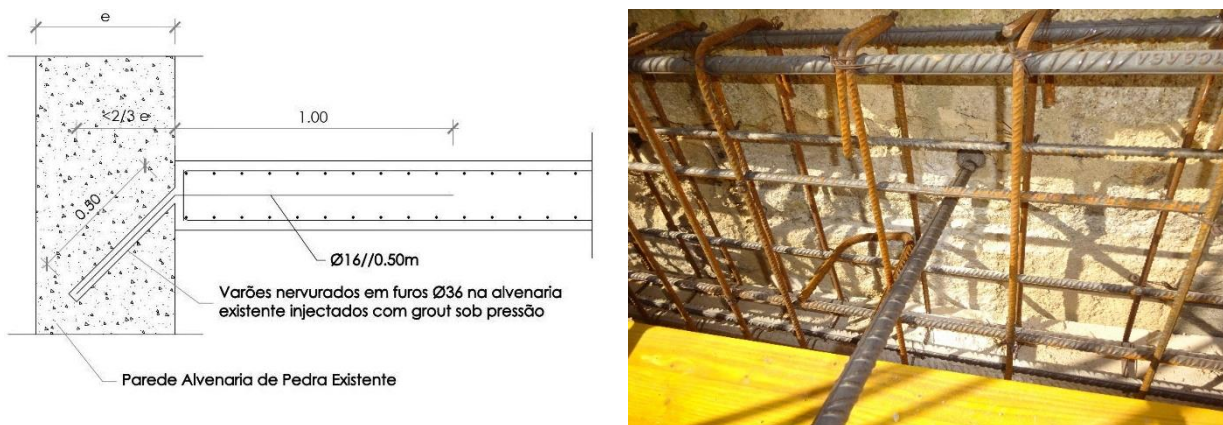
Pormenor de ligação das lajes à parede de fachada existente e a manter [4]
